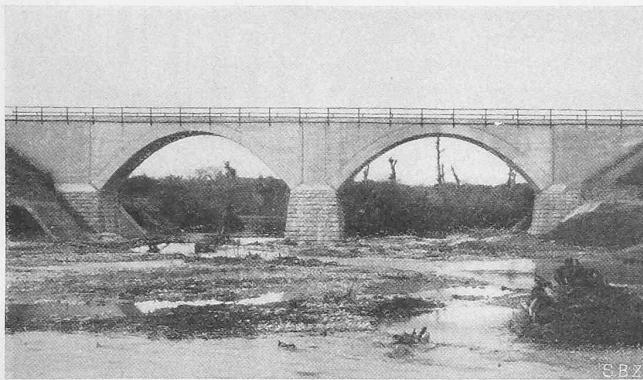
Eisenbetonbrücke bei Outoudjan, Km. 140,1.
